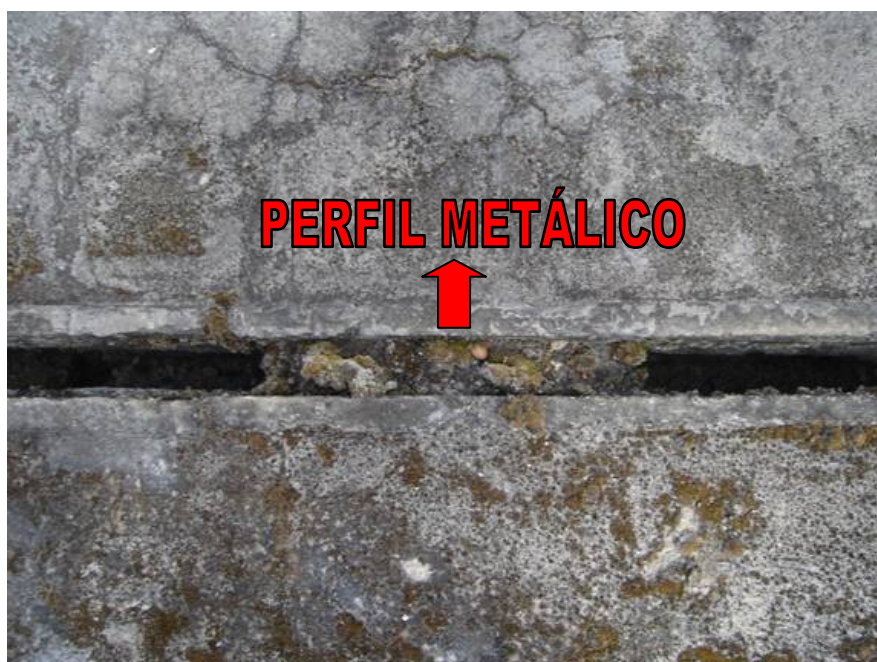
Perfil metálico revestidos dos elementos de ligação transversal
